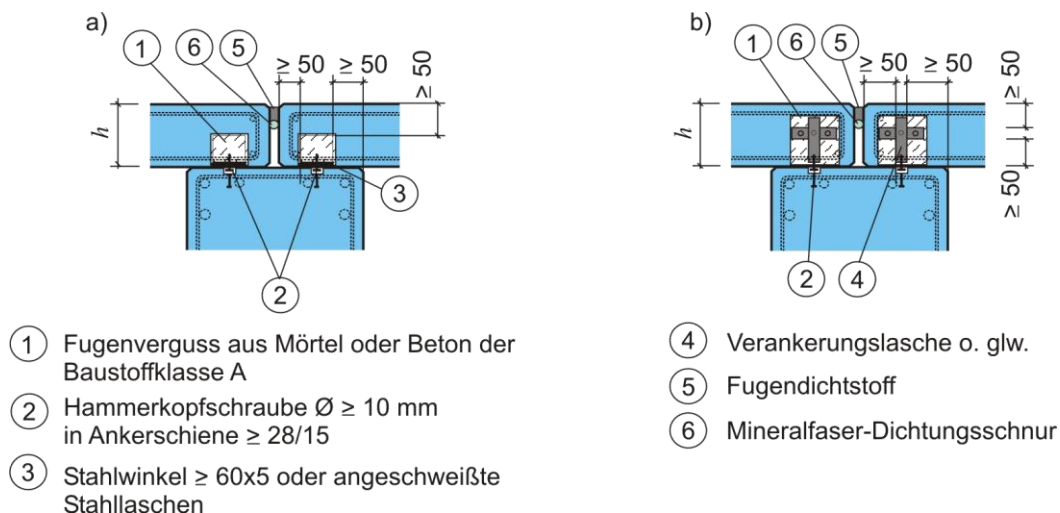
Anschlüsse von Fertigteil-Brandwänden vor Stahlbetonbauteilen, a) mit Stahlwinkel, b) mit Verankerungslaschen
